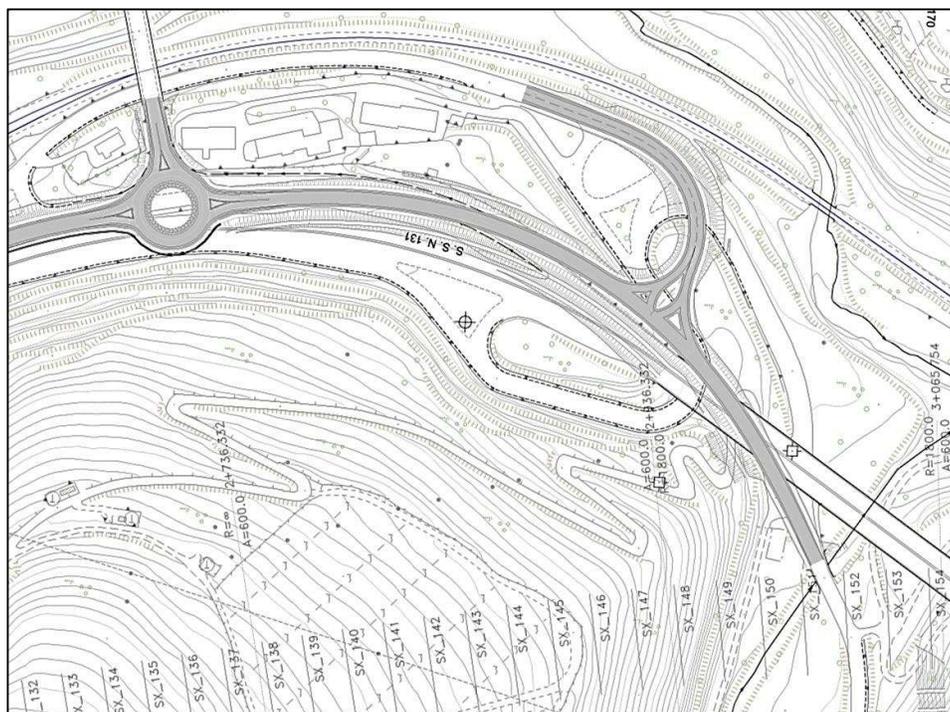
Nuovo collegamento con la SS127 e bretella di collegamento alla viabilità esistente.
